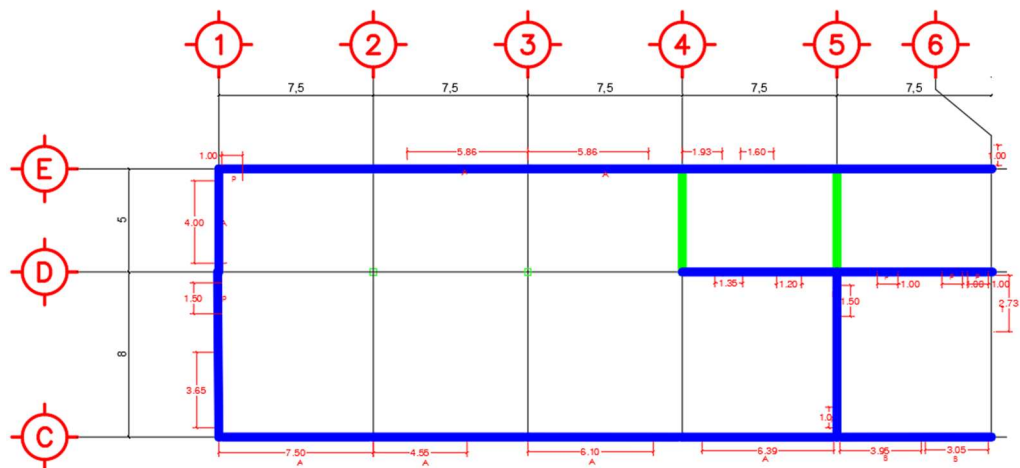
Mampostería a considerar en $Nv+0.18$ en modelado de la estructura I
